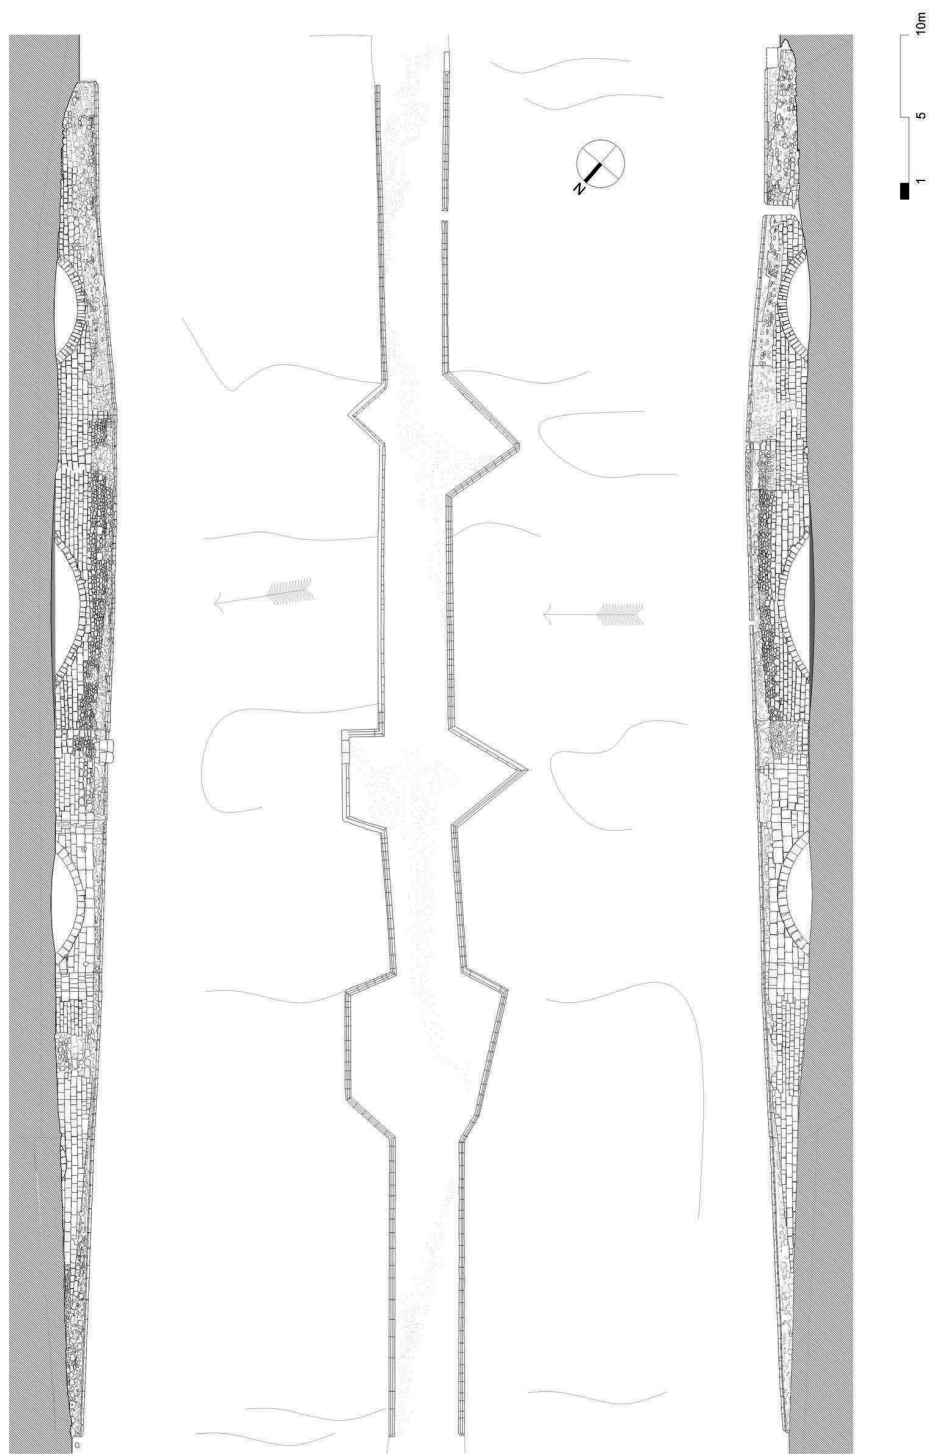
Planta y alzados del Puente Viejo de Maderuelo en su estado actual.
